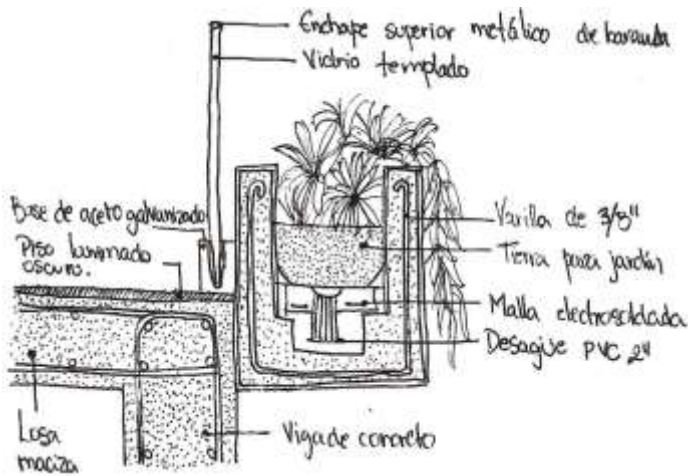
Detalle de jardinera en Torres. Fuente: Elaboración Propia.
